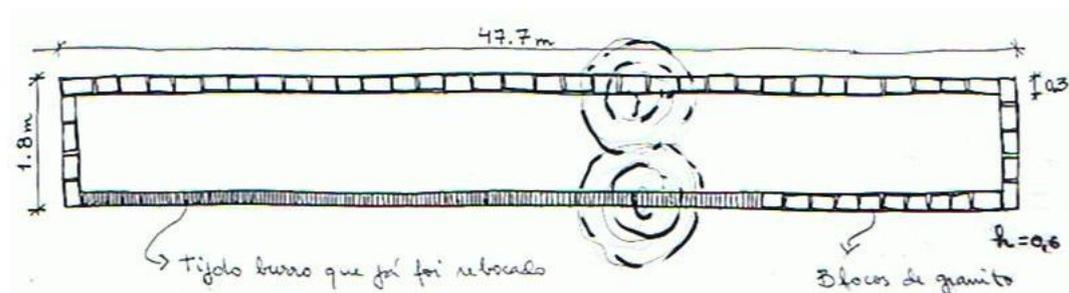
Bebedouro para gado de grande dimensão – planta. Fonte: desenho da autora
